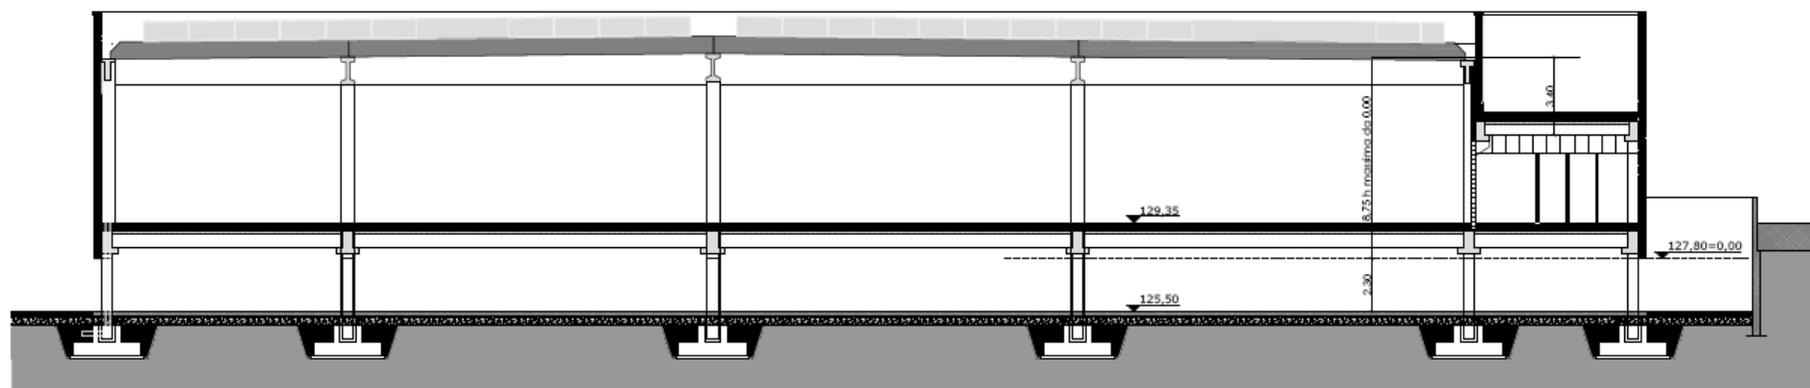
Prospetto sud con vasca antincendio (Variante approvata - Tavola 3b)
